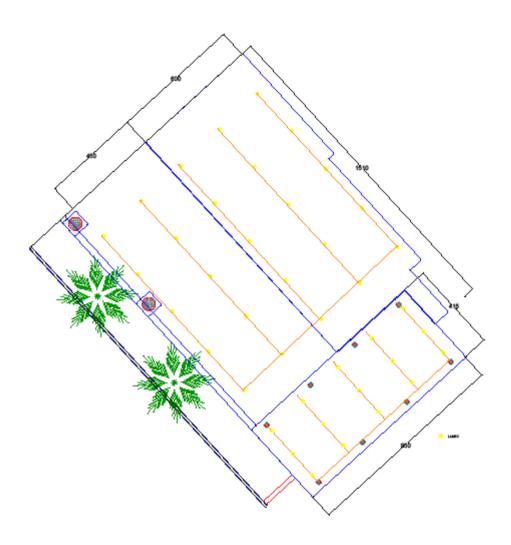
Denah Ruang Terpilih 2 (Mini Bar & Pool)
